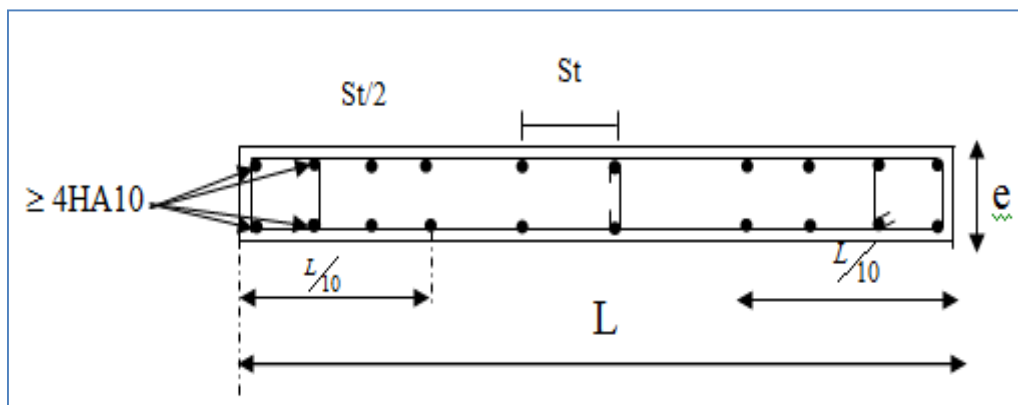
Disposition des armatures verticales dans les voiles
